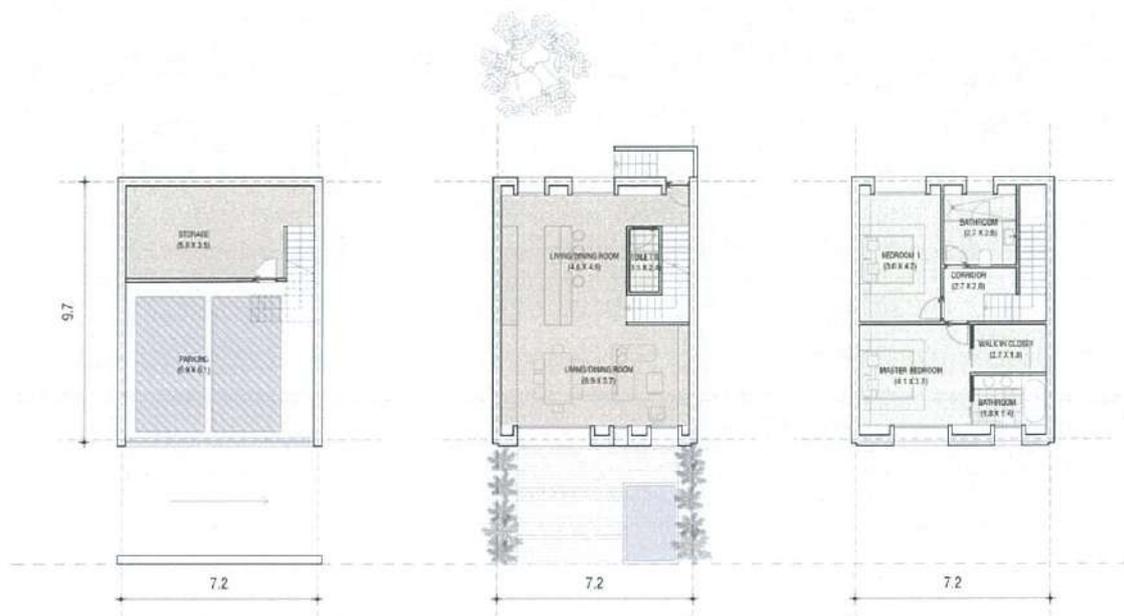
Plani i parkimit, katit përdhe dhe katit të parë të Vilës A
